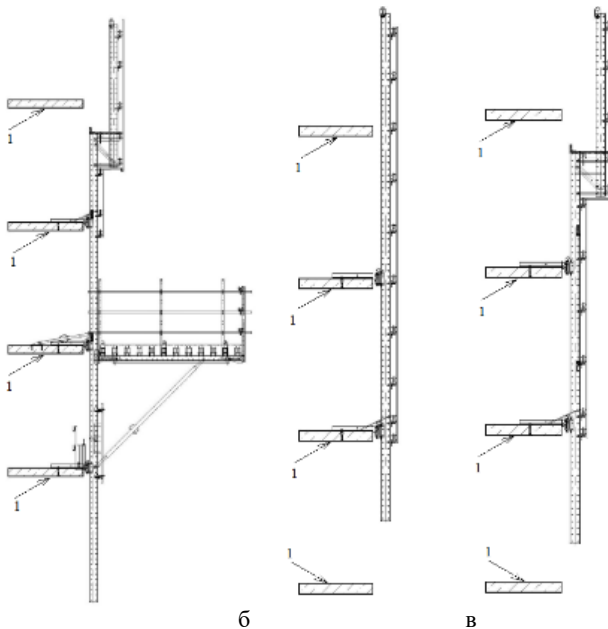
Типи панелей, де 1 – плита перекриття: а – z-подібна з вантажною площадкою; б – пряма; в - z-подібна
